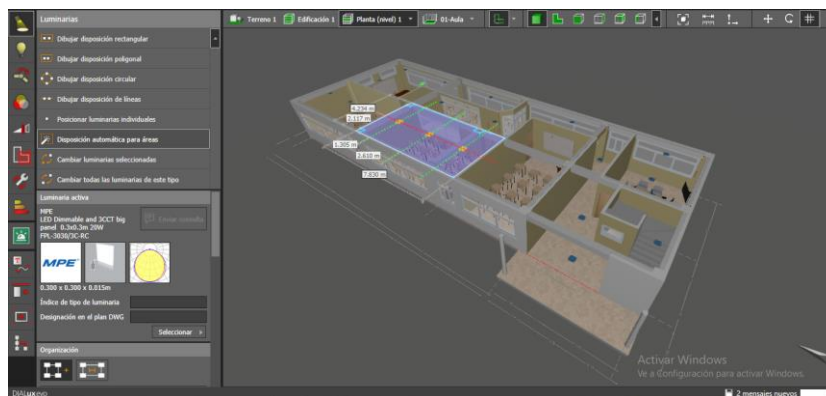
Planta baja, implementación de paneles LED dimerizables.
